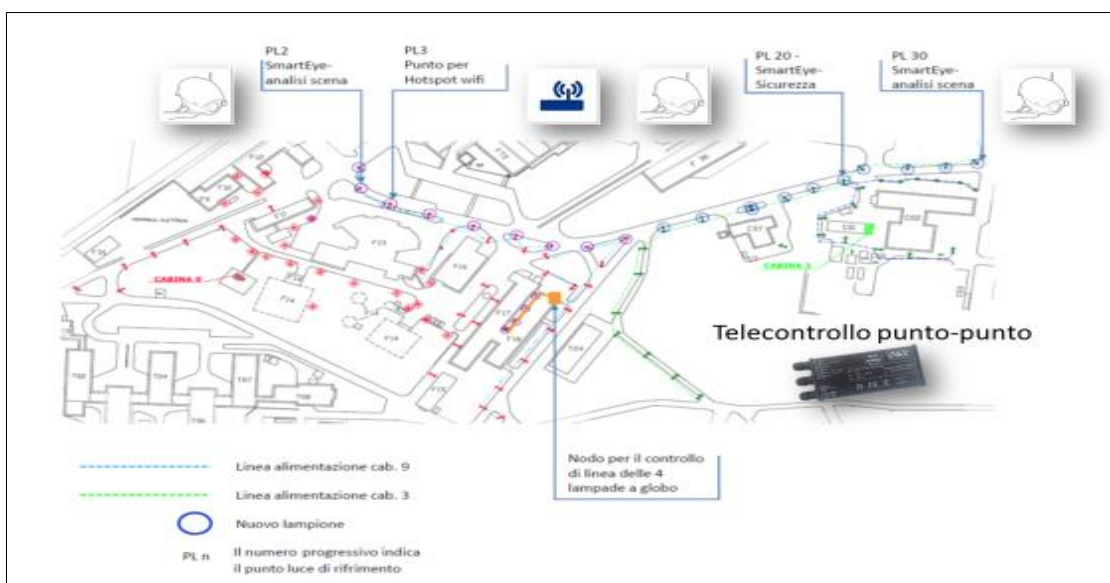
planimetria di smart street prototipale (CR Casaccia)
